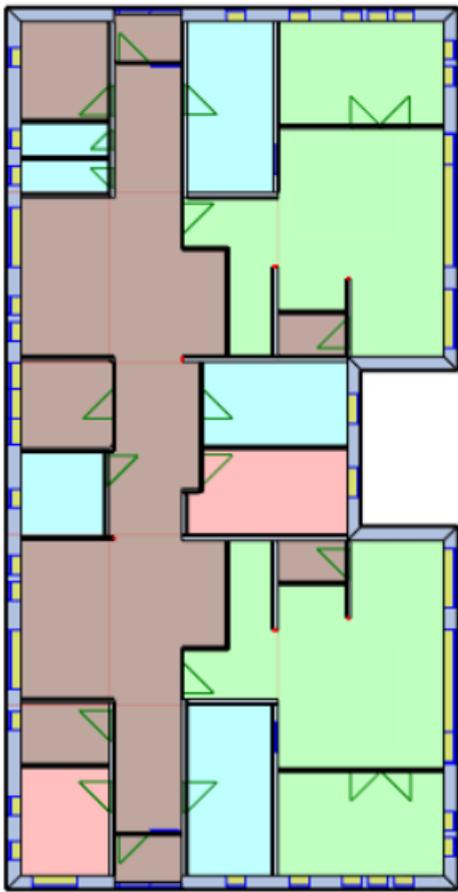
Grundriss Erdgeschoss, zoniert
